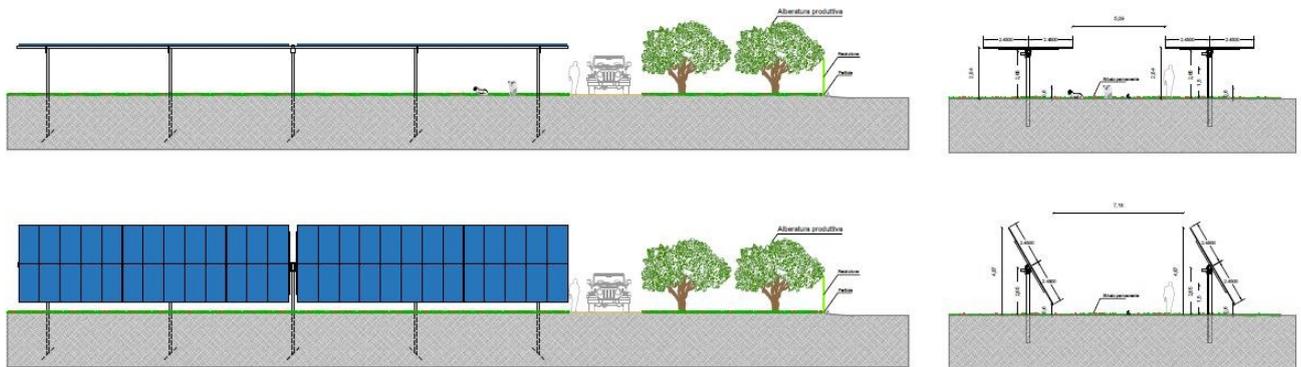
Sezione significativa del sistema di mitigazione perimetrale
